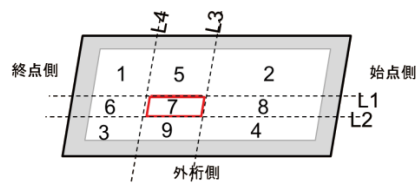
輪荷重走行試験後切断試験 (供試体 No. 1 貫通ひび割れあり)
